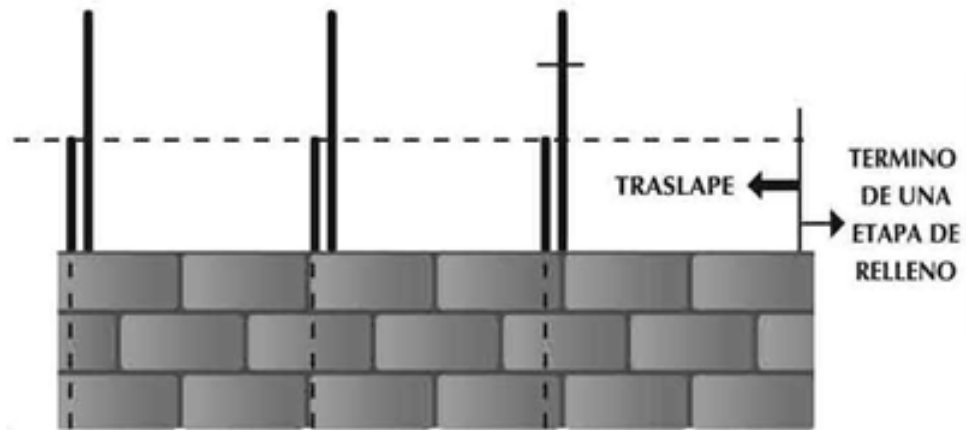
Empalme por traslape de las barras de refuerzo vertical de un muro de A.A (Bravo, 2007)
